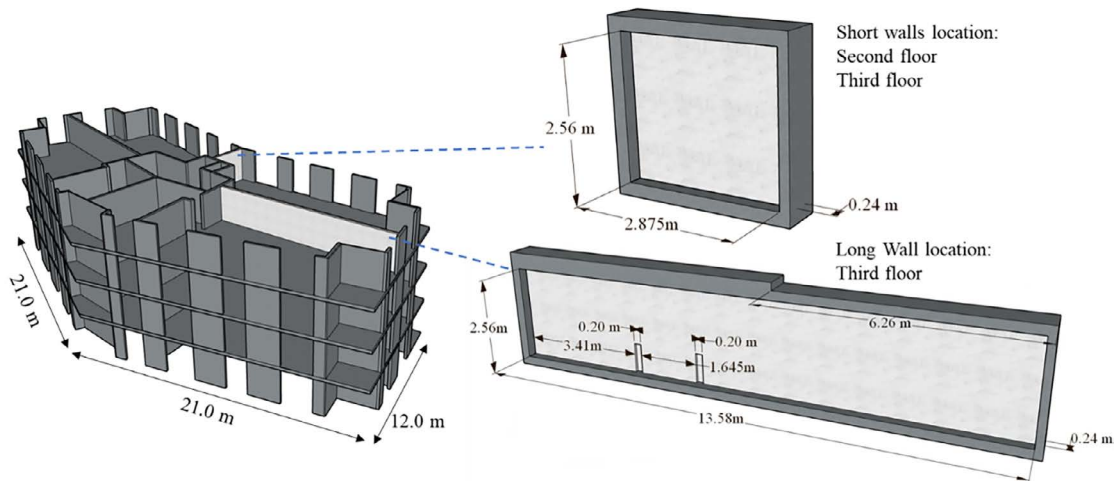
Vista general del edificio y ubicación y vista detallada de los muros de MSFRC (un muro largo y dos muros cortos).
